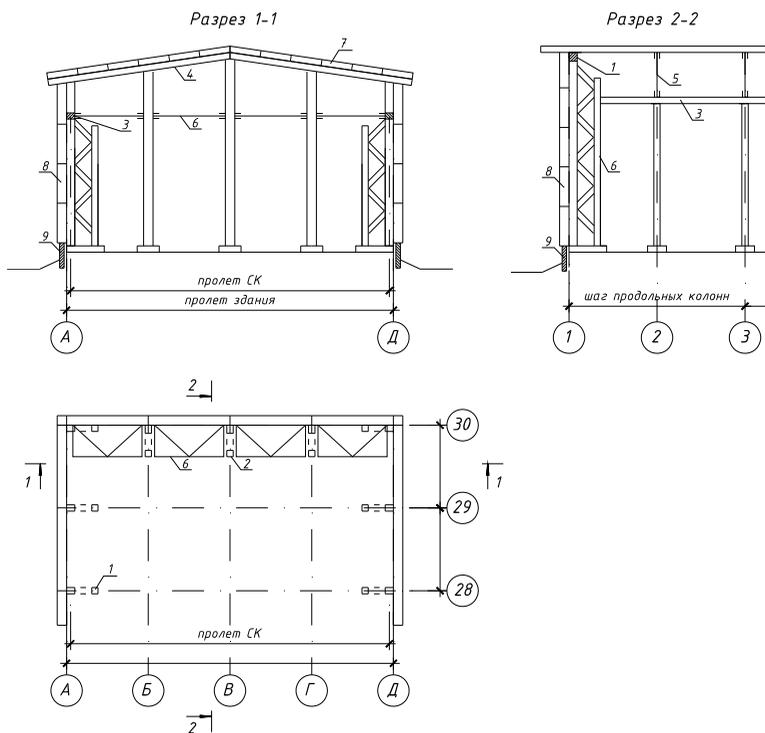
Здание, в котором отсутствуют несущие фермы в торцах:
